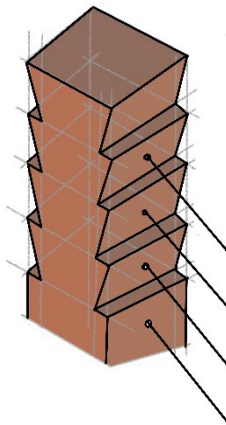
Esquema de la parte superior de las columnas del puente de Sevilla.
